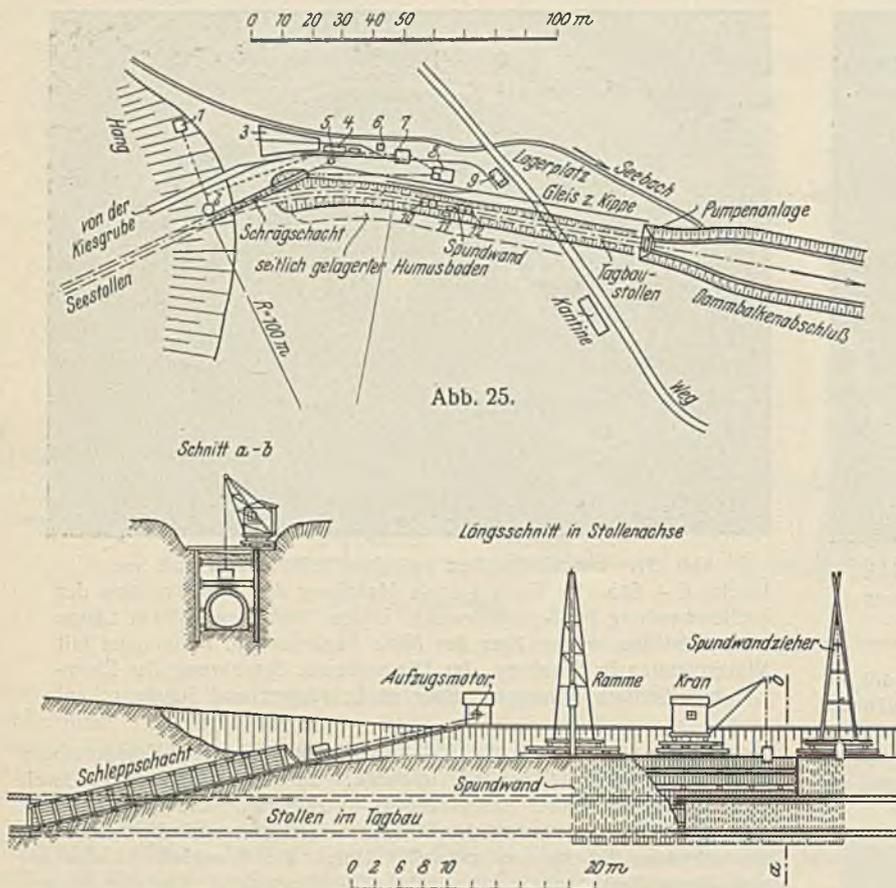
Baustelleneinrichtung am Ende des Stollens B.
